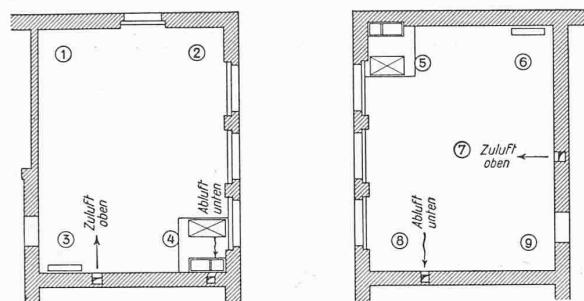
Temperatur-Messungen in zwei Schulzimmern. — Grundrisse 1 : 250.
